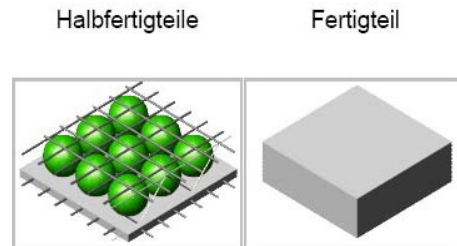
(oben): BubbleDeck mit Bauteilaktivierung
